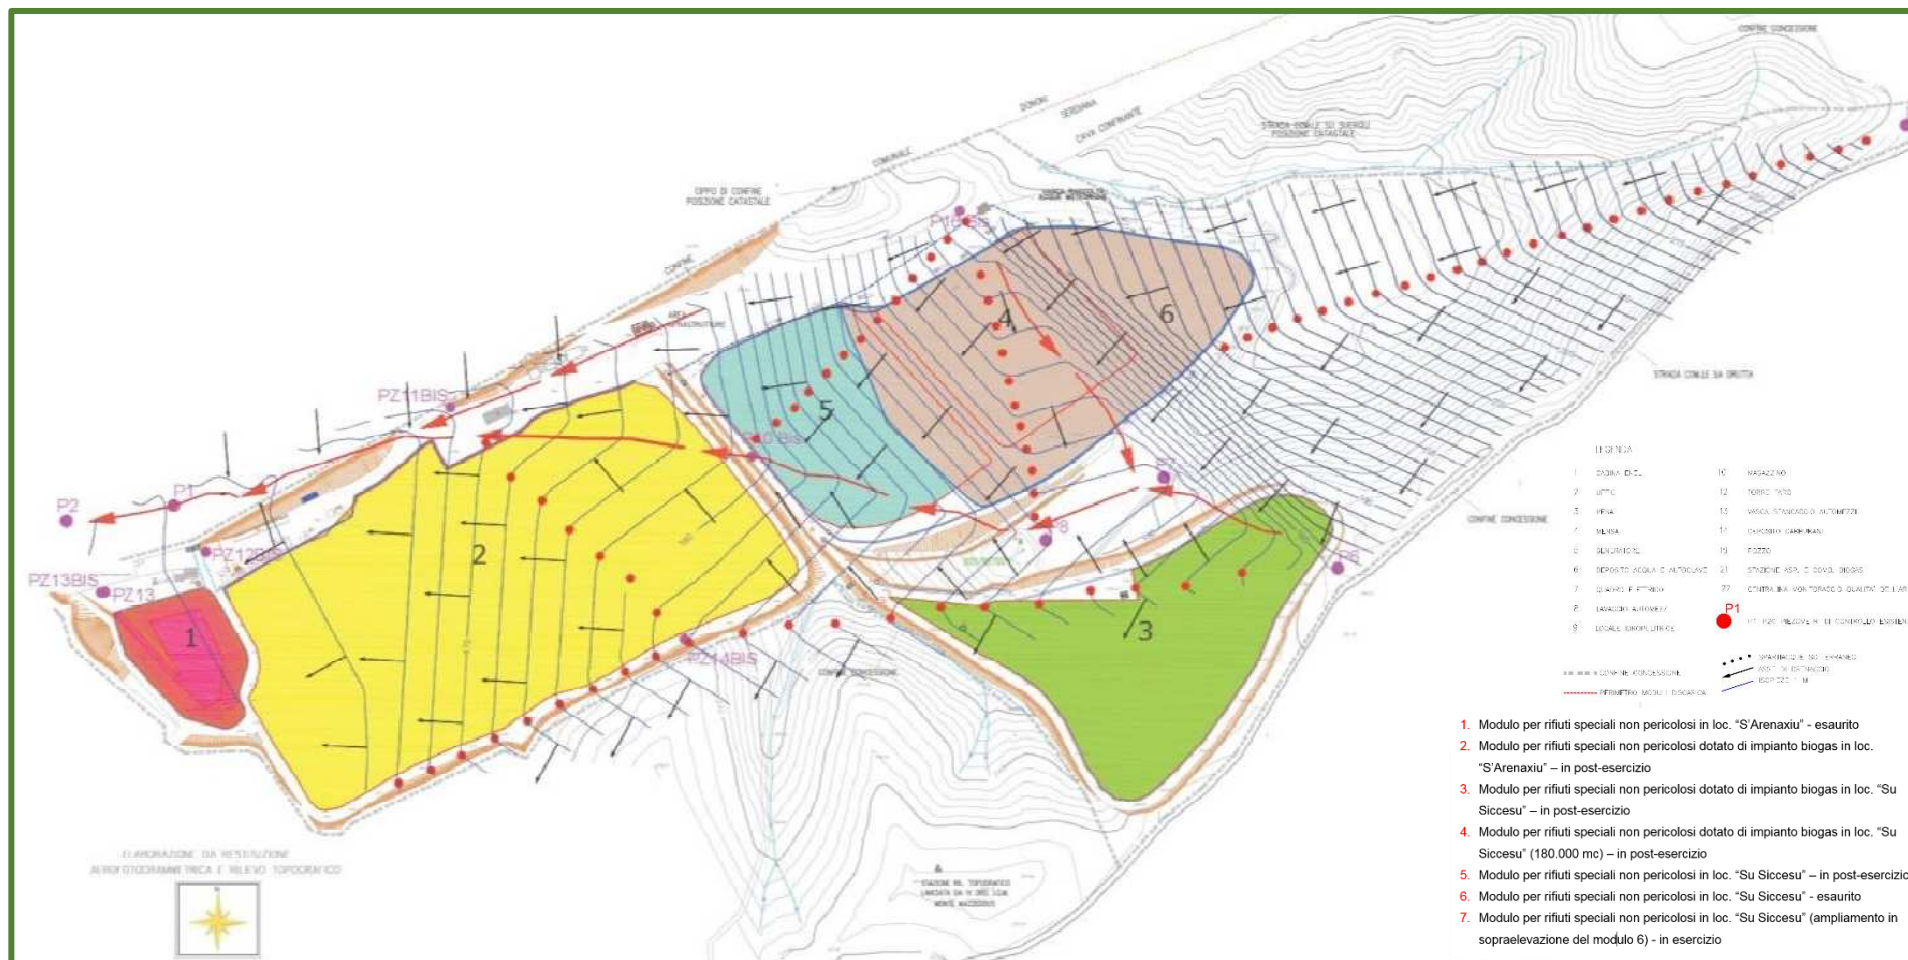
/II: Planimetria rete di monitoraggio principale dal 2021
